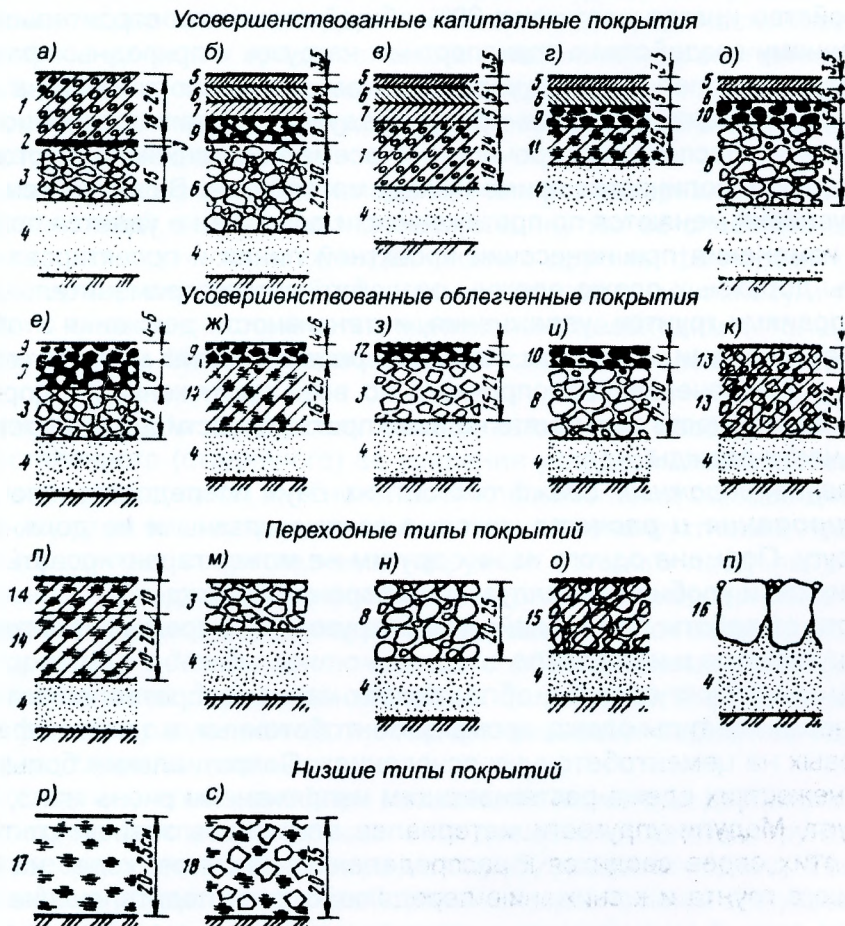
Примеры конструкций дорожных одежд: а – цементобетонное покрытие на каменном основании; б – асфальтобетонное покрытие на гравийном основании; в – двухслойное асфальтобетонное покрытие на бетонном основании (применяется на городских улицах); г – асфальтобе-
